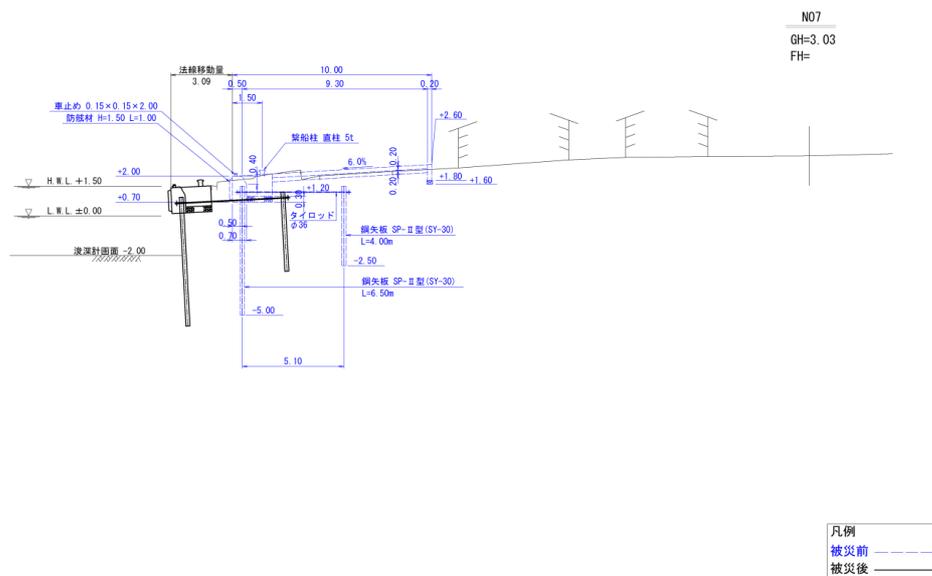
No.15 日立港区_第5埠頭地区第2船だまりの東2断面図(被災前・後)
